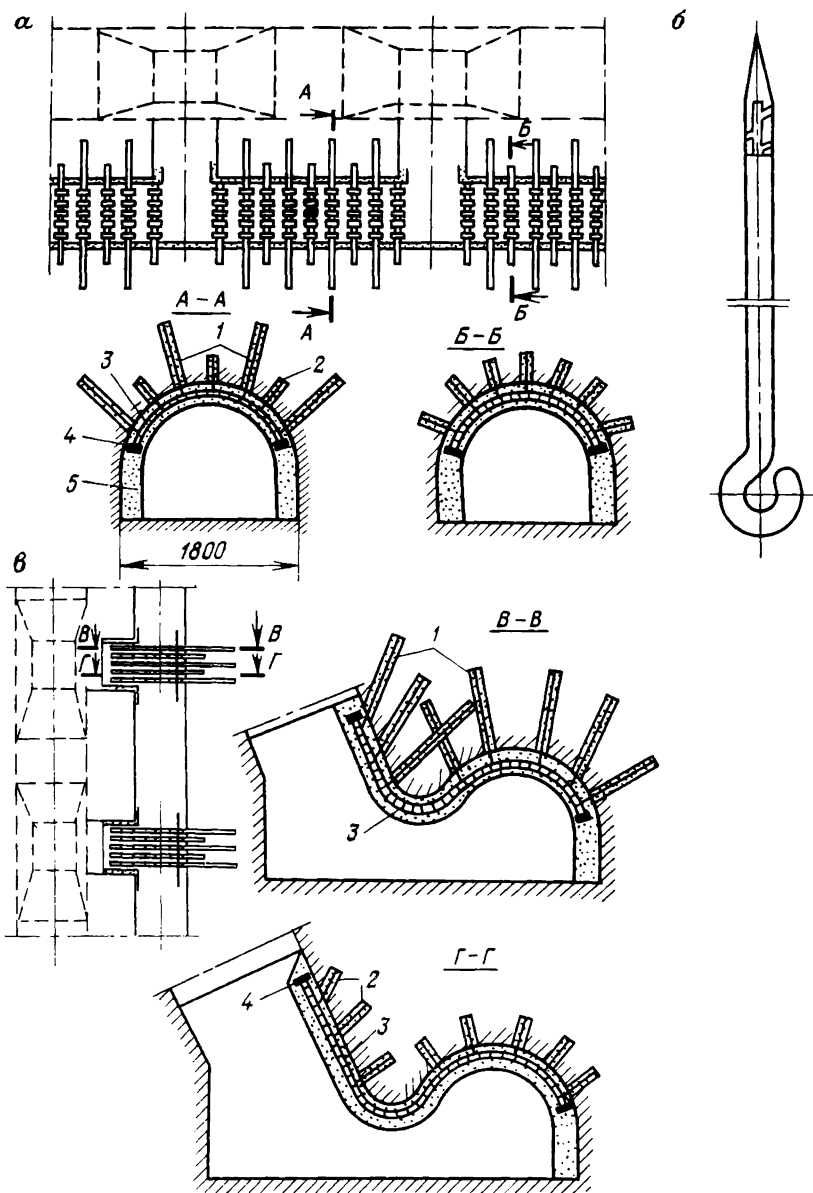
Варианты крепления выработок с нанесением набрызгбетонного покрытия и установкой железобетонных анкеров разной длины и металлургических тросов
